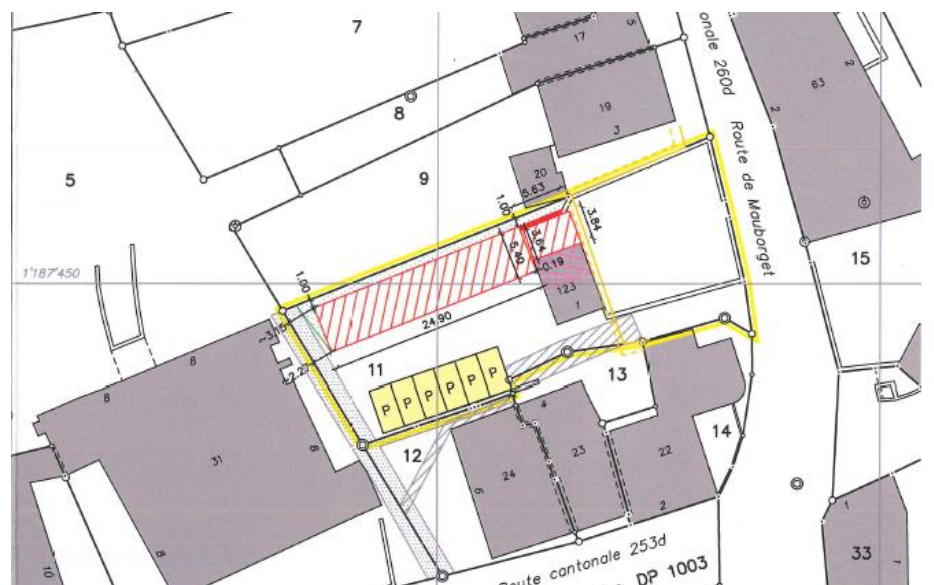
Extrait du plan dressé pour enquête (2022) sur la parcelle n°11
